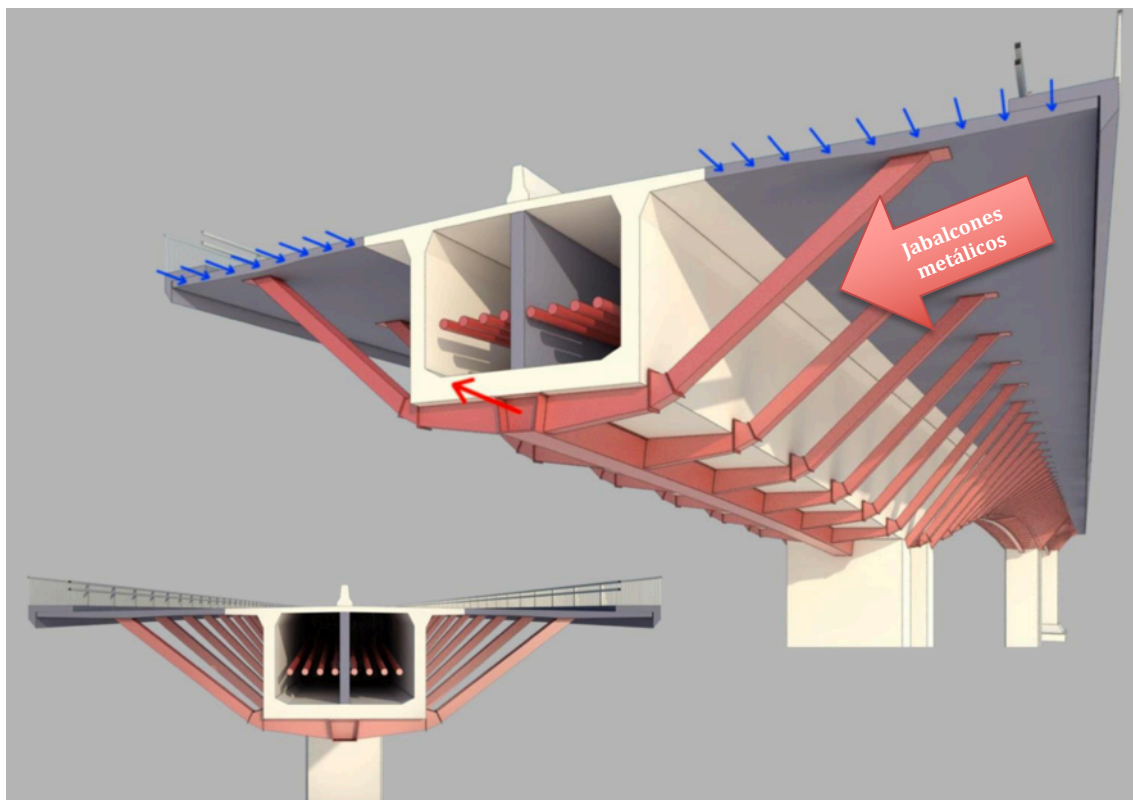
Animación 3D de la colocación de jabalcones metálicos y vista transversal y longitudinal del puente una vez realizada la ampliación. [15] (Sanchez Delgado)
